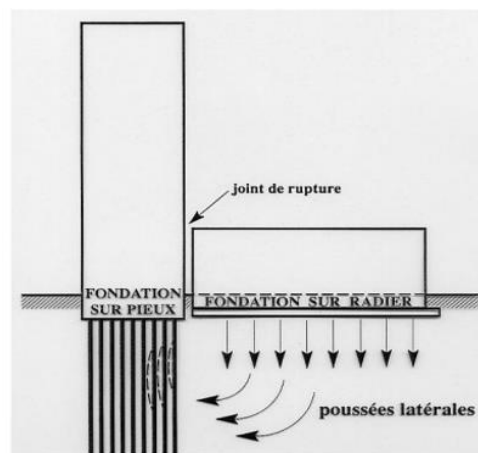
Constructions voisines risque de déstabiliser le bâtiment [13]
